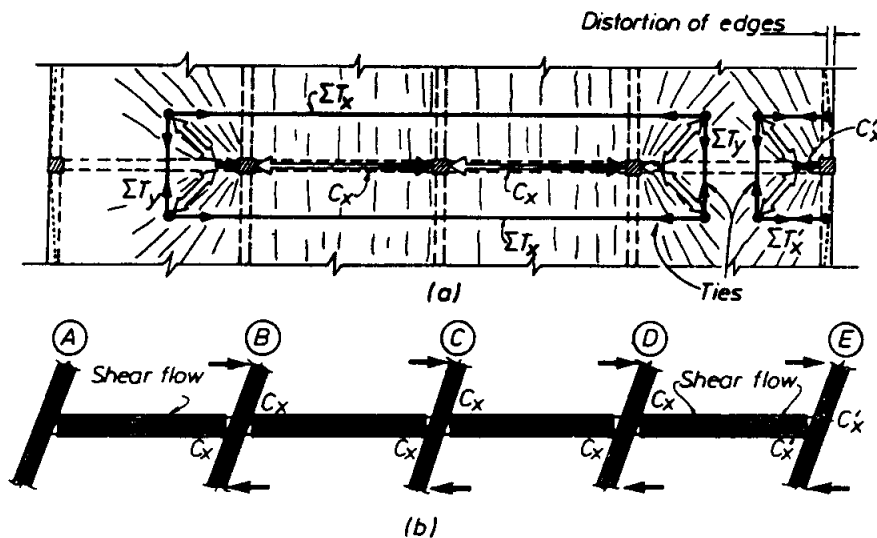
Mécanismes de semelle tendue dans les poutres continues
